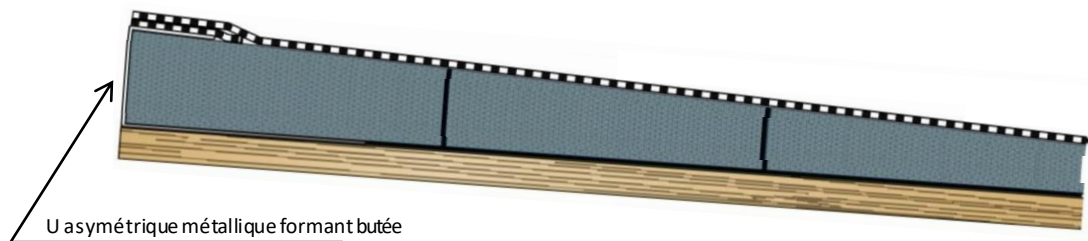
Coupe de principe sur rive sans acrotère, sur élément porteur bois - panneaux à base de bois¹
